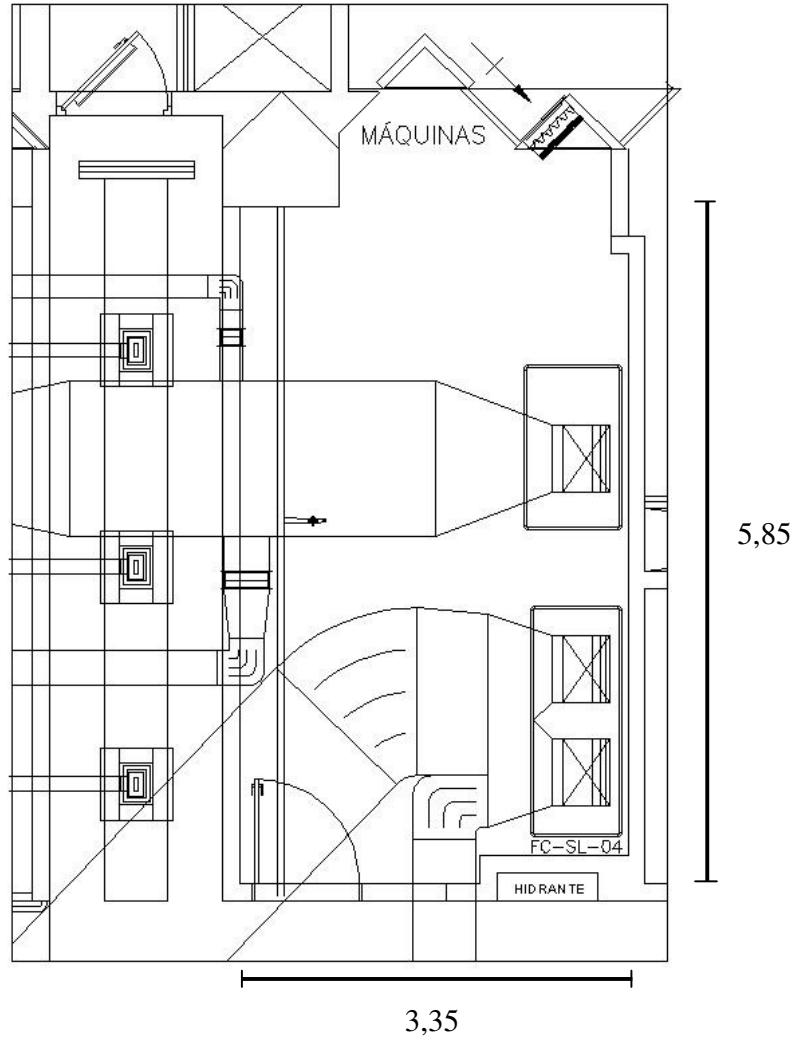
Planta baixa – Sala de *fan-coil* em pavimento – s/ escala
